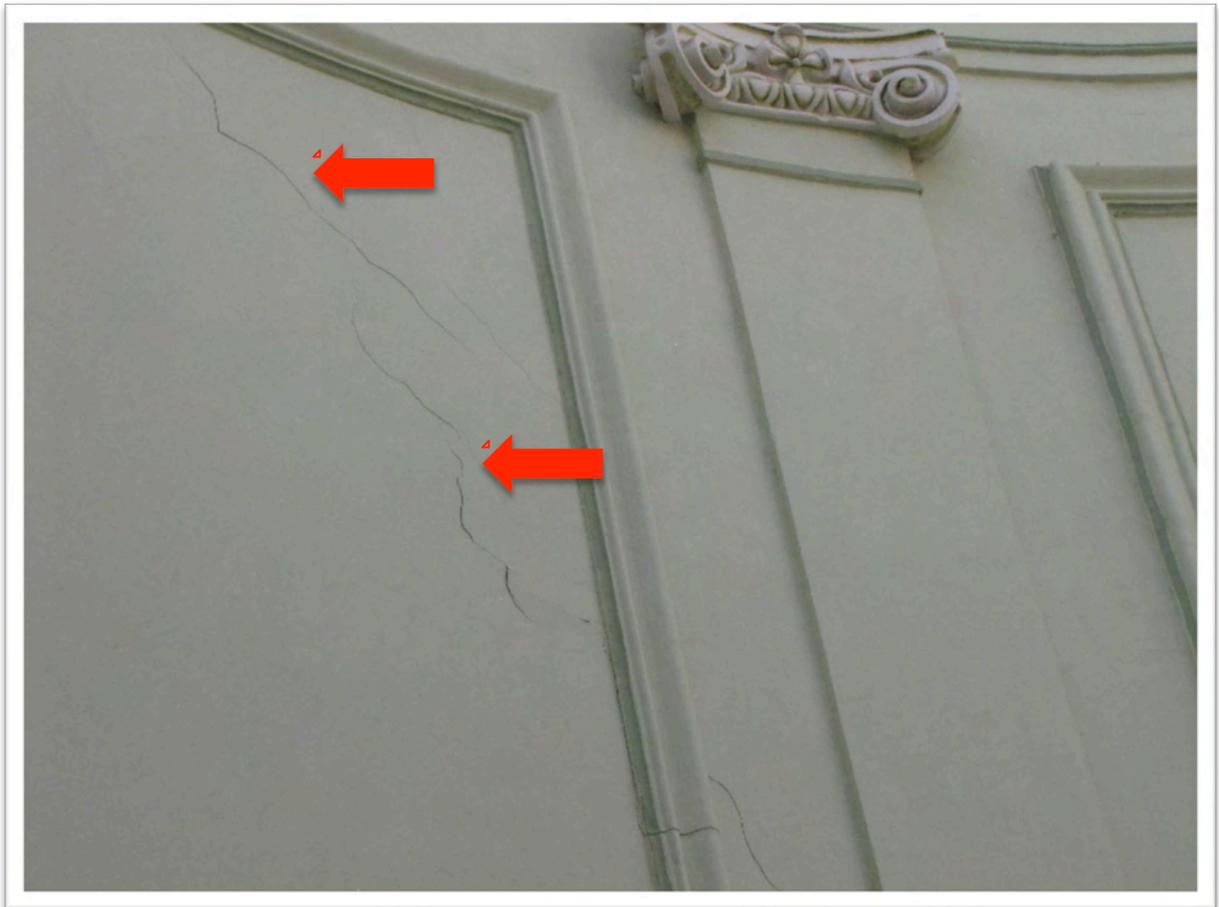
Grietas con trayectoria diagonal en muros de escalera.
